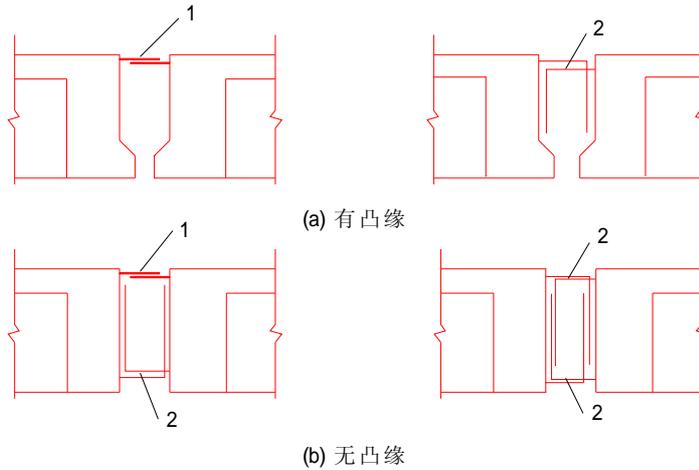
框架梁的明槽两侧楼板之间连接钢筋
